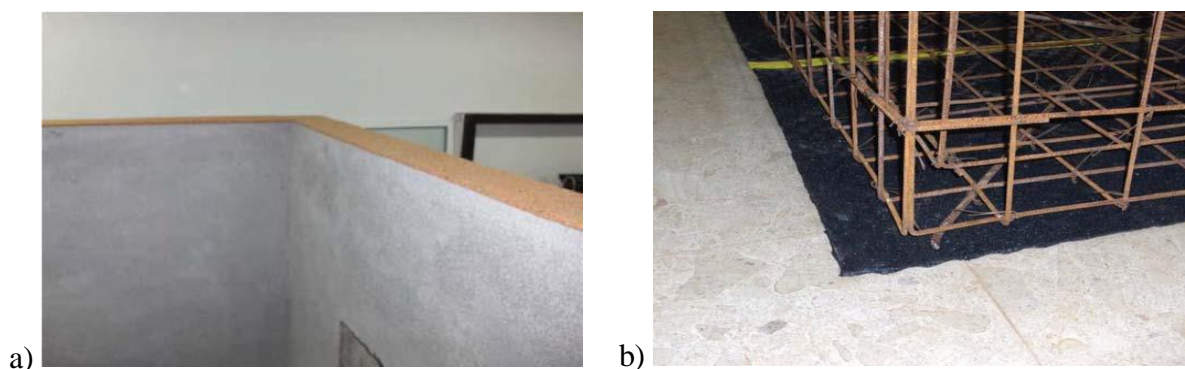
Pormenor construtivo da câmara acústica de dimensões reduzidas (Godinho *et al.*, 2010): a) aglomerado de cortiça ao longo da face superior da parede; b) aglomerado de borracha sob o piso da câmara.
